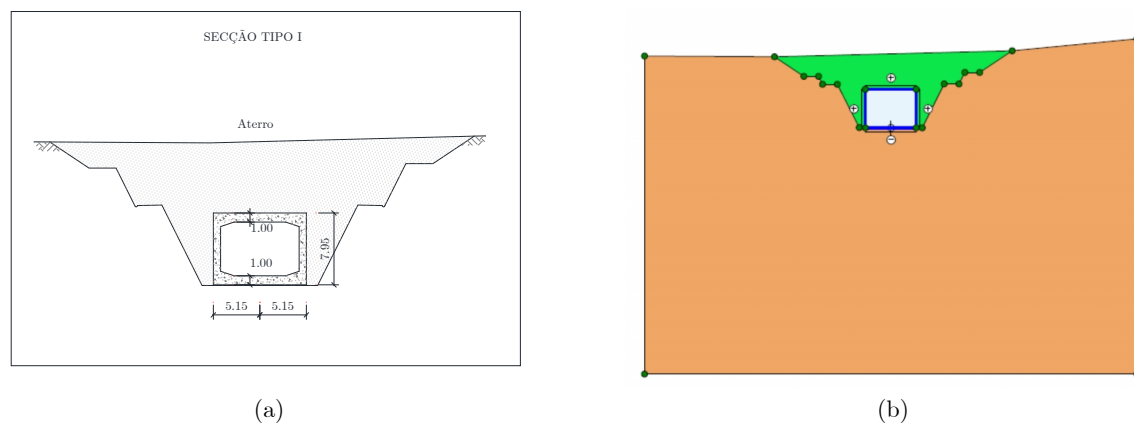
Cortes transversais: (a) Modelo 2 – corte transversal tipo; (b) Modelo estrutural executado no PLAXIS.
